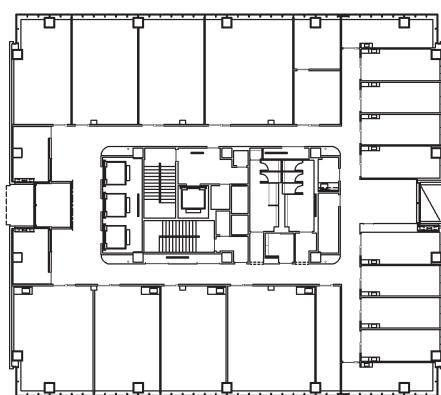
(1) 高層棟平面図（地下1階～地上5階）(1/3)
